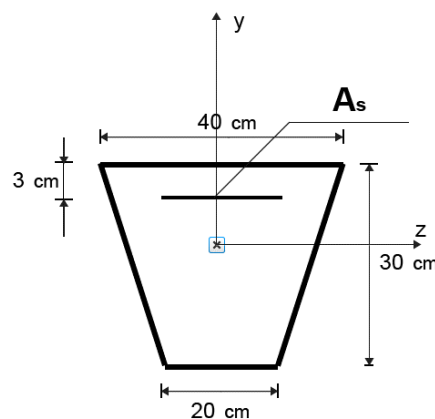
Seção trapezoidal e disposição das armaduras para a V1
